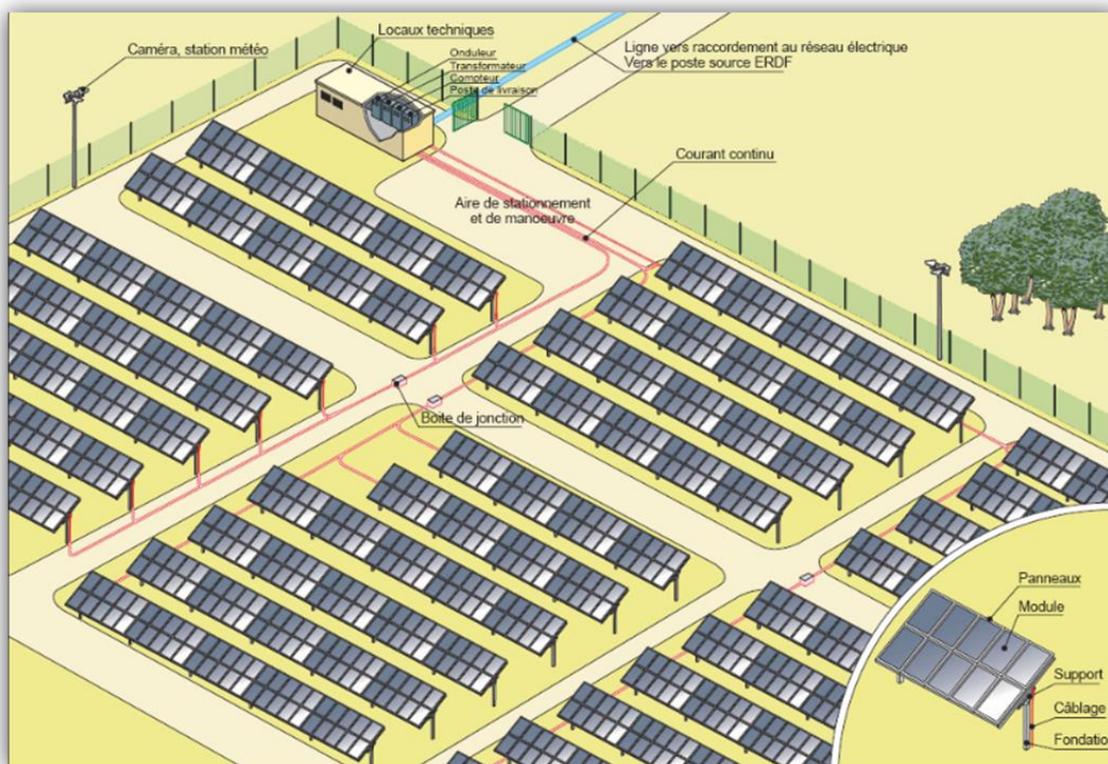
Plan théorique d'une centrale photovoltaïque au sol
